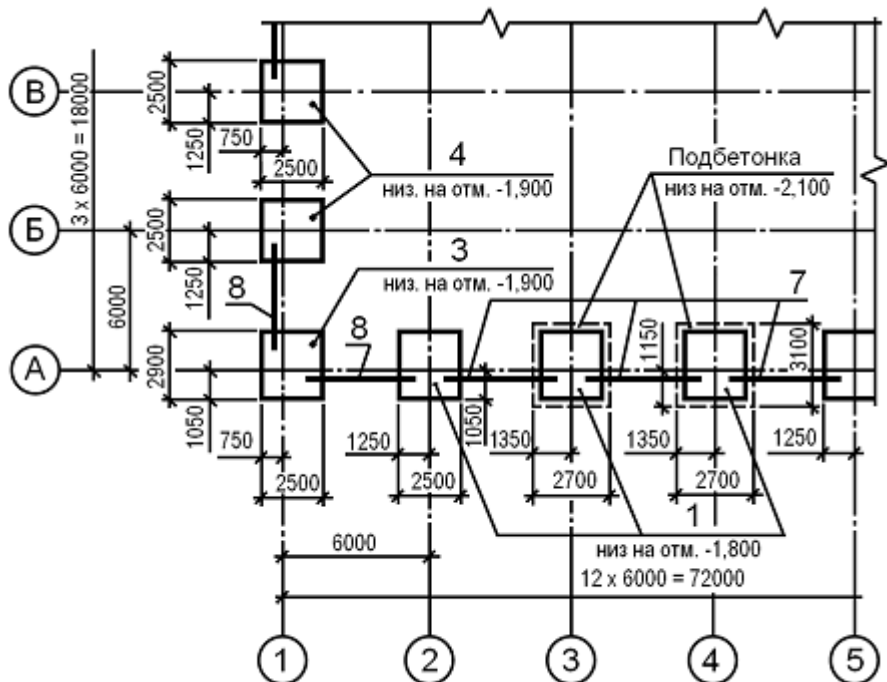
Схема расположения элементов фундаментов и фундаментных балок
